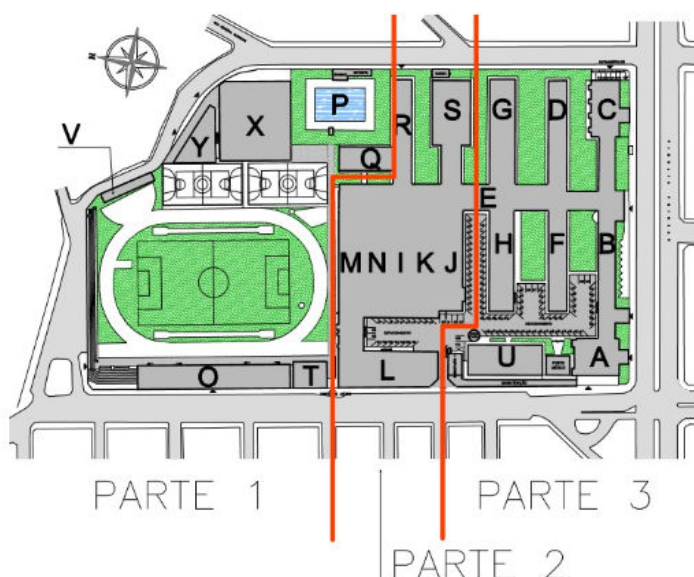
Planta de situação do Ifes - Campus Vitória e área de interesse (parte 2)
